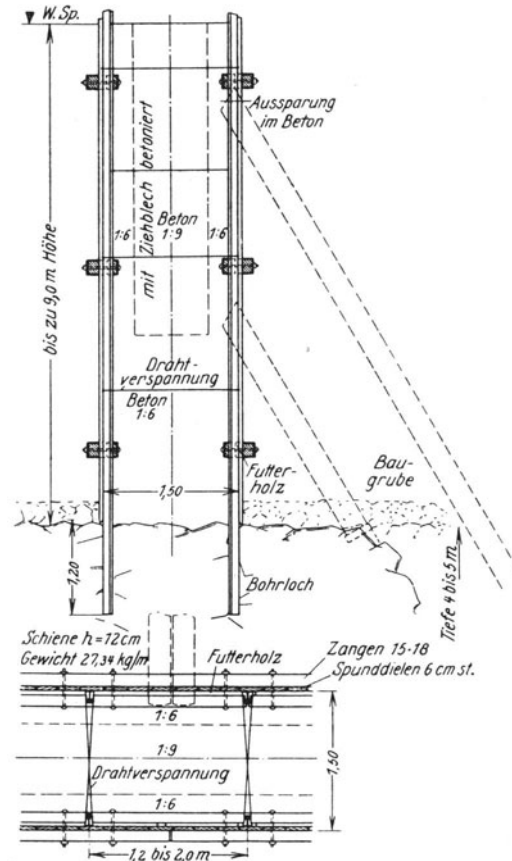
Betonfangdamm beim Bau des Kachletwerkes bei Passau. (Nach Hetzel: Bautechnik 1926.)
